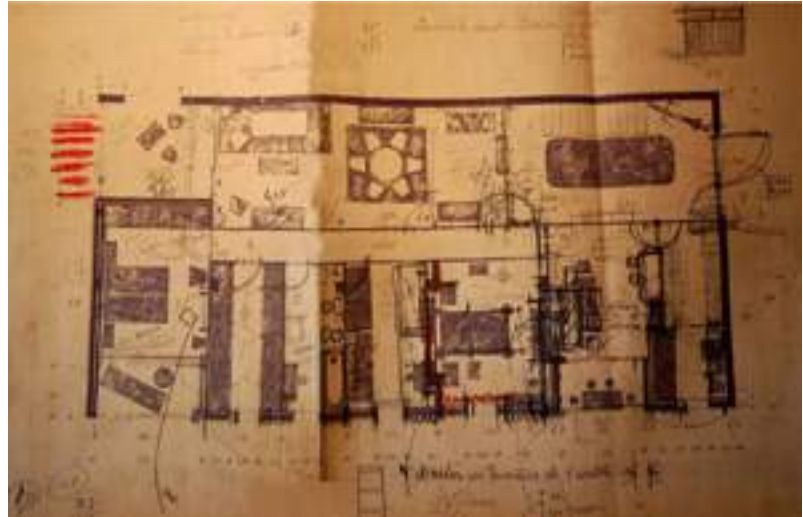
Croquis inicial. (Fuente: Artículo de José Ramón Puerto en ocasión del centenario del arquitecto. 1964 c.)
